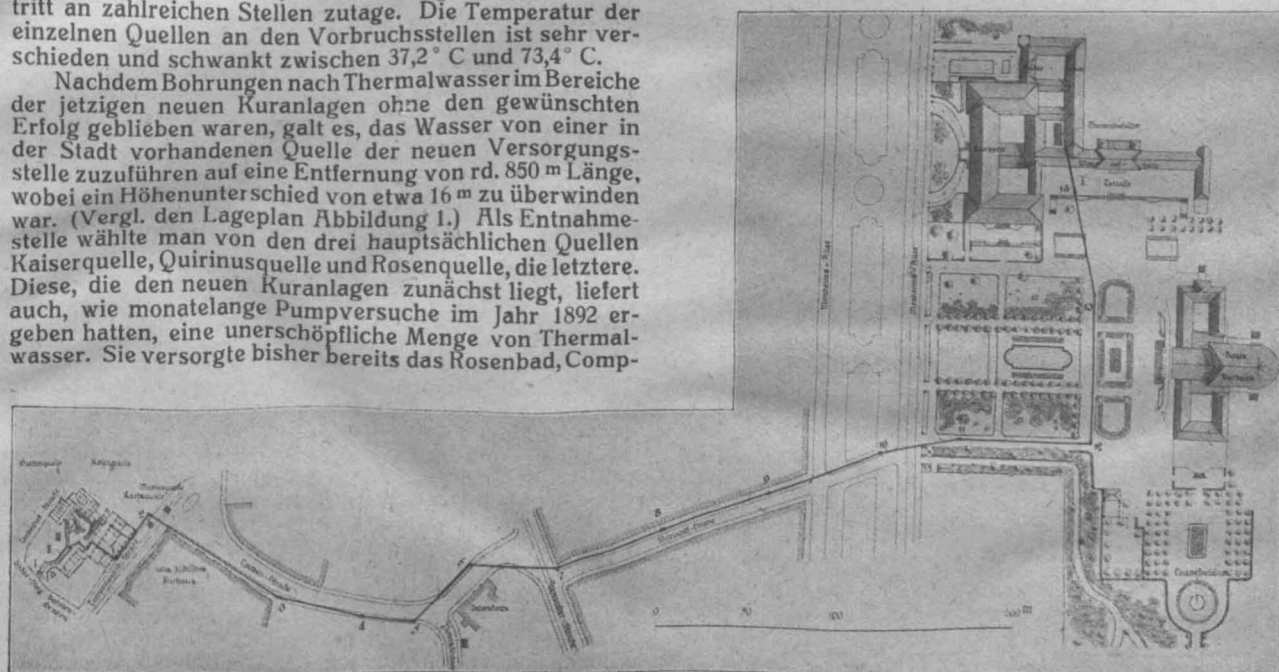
Thermalleitung Bad Aachen. Lageplan der alten und neuen Anlagen.
